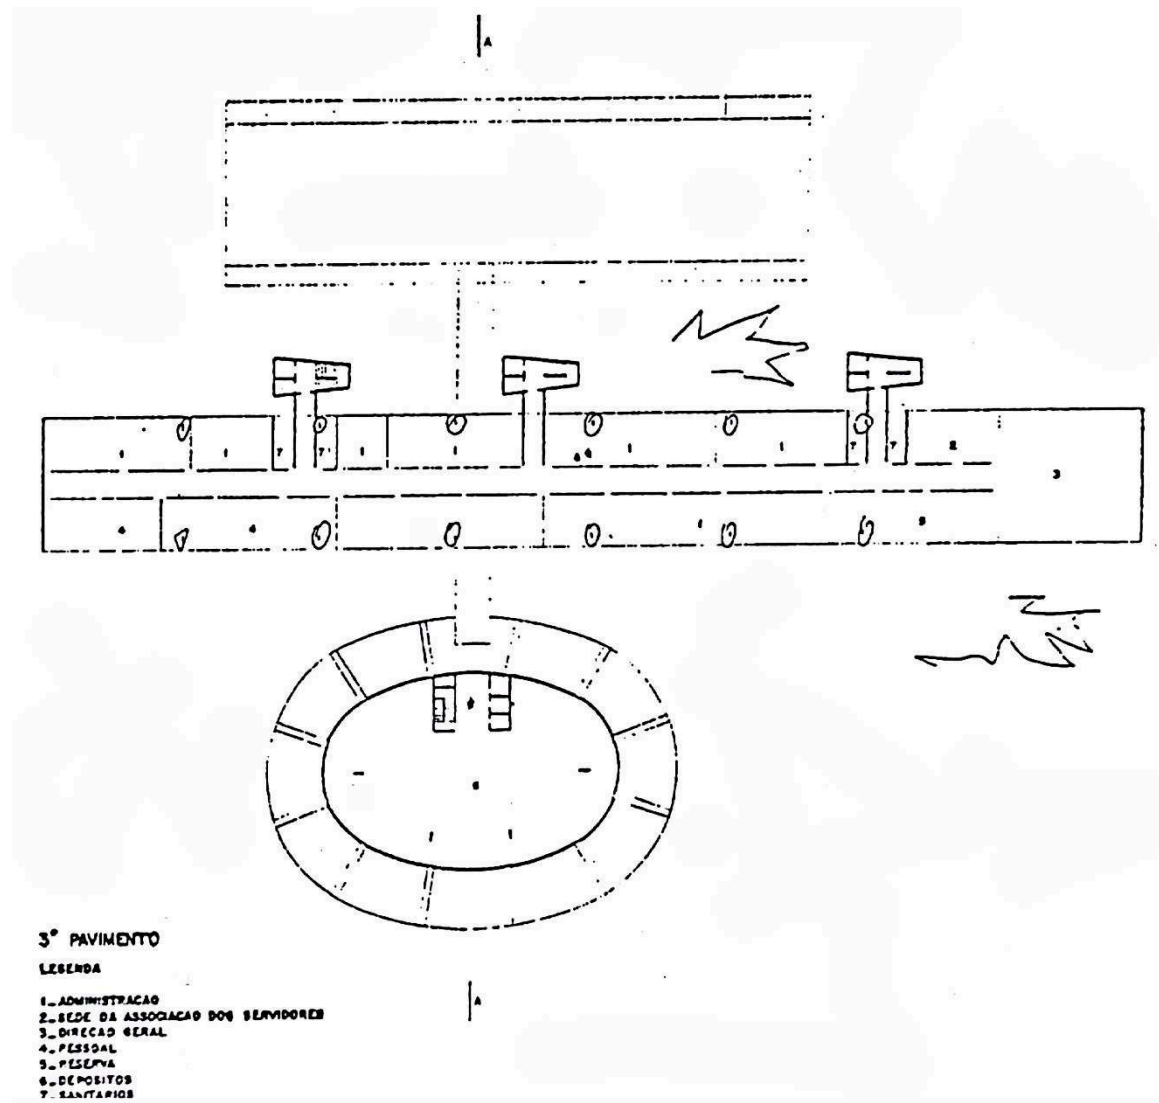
Planta do 3.º pavimento do Arquivo Público, 1988-90. Fonte: Arquivo Ministério da Cultura.
